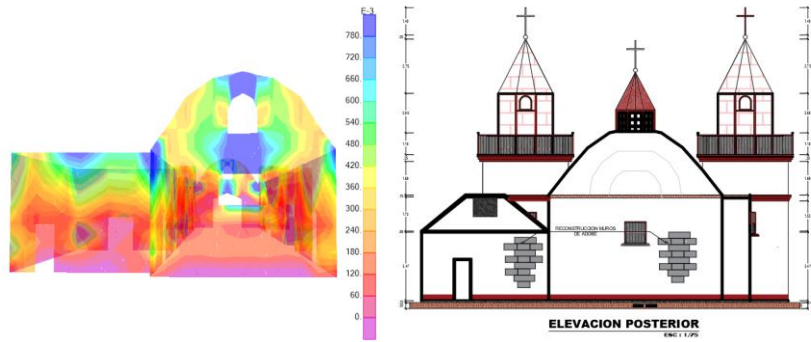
Grietas formadas a causa de esfuerzos a flexión en muro posterior.
